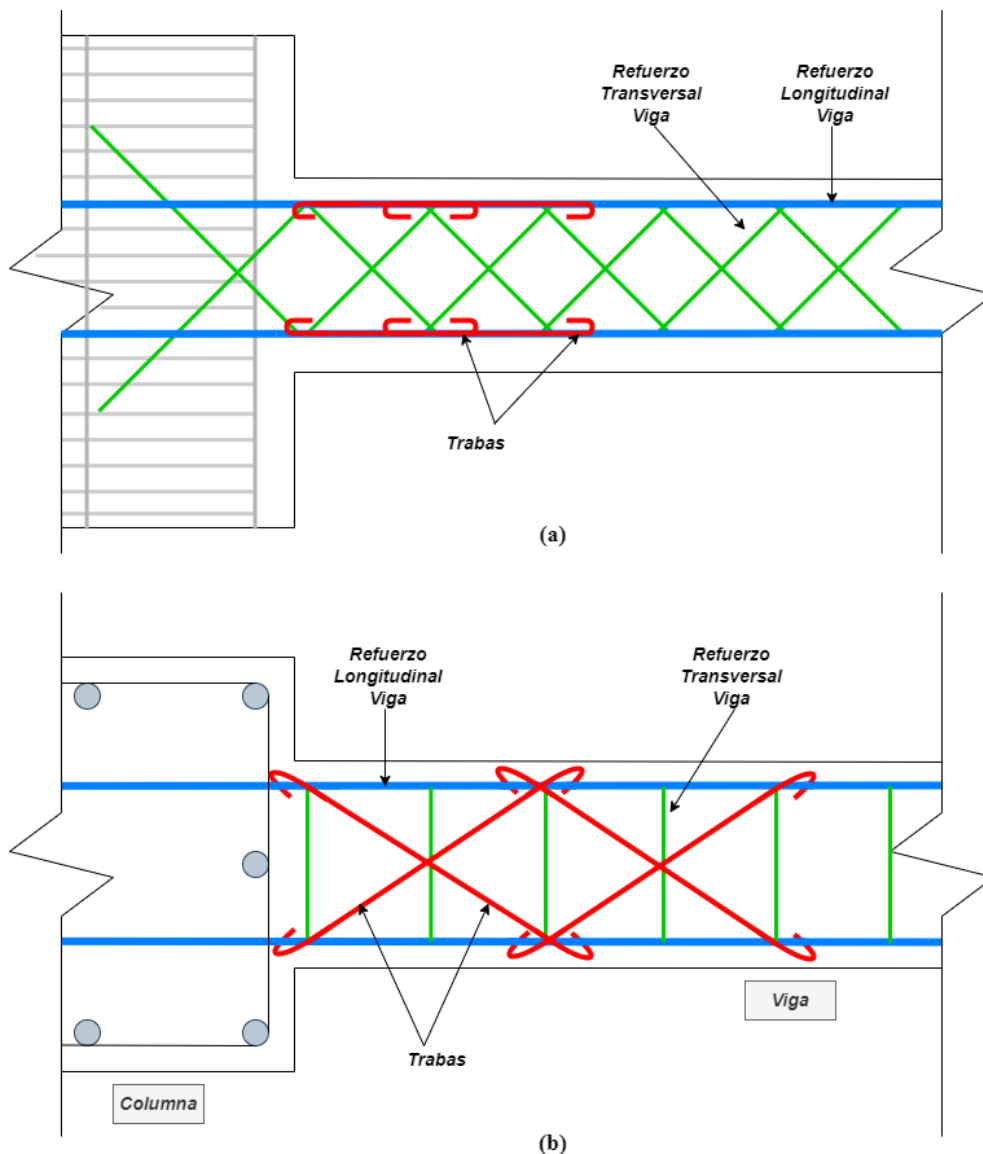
Esquema de probeta con armadura adicional: (a) Vista en elevación; (b) Vista en planta
